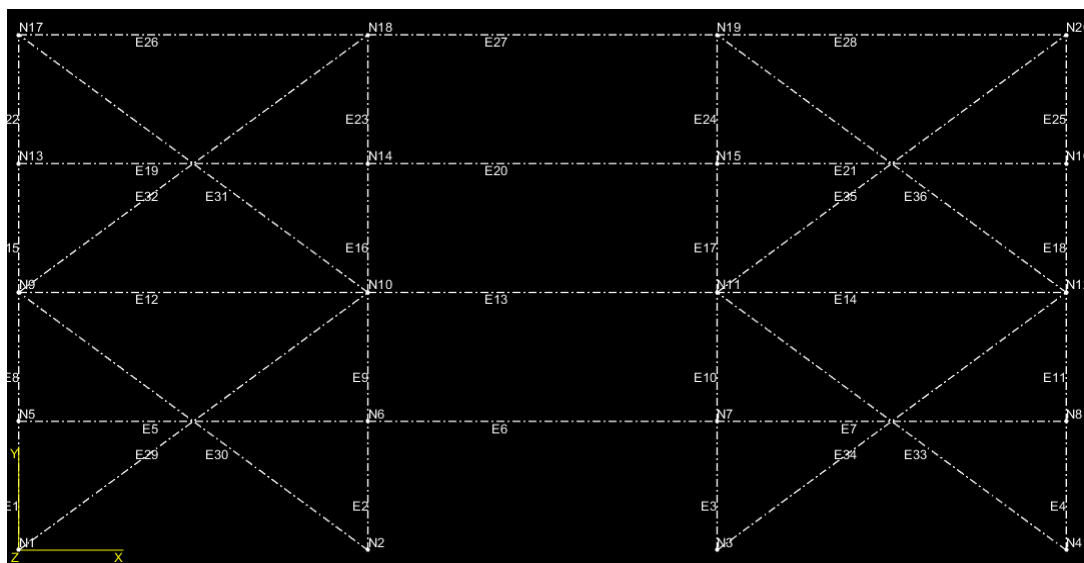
Sistema de contraventamento no pórtico secundário
